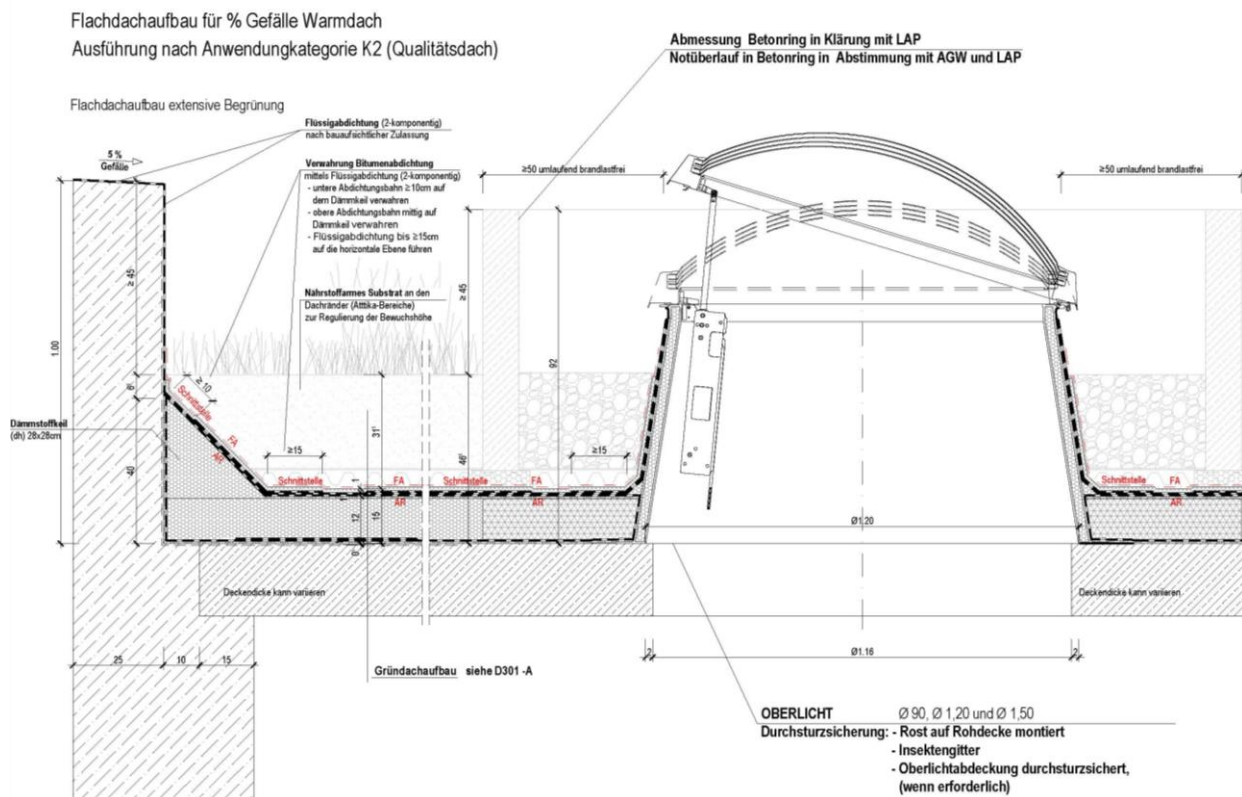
Dach Oberlichtkuppeln - Anprallschutz Dachflächen
